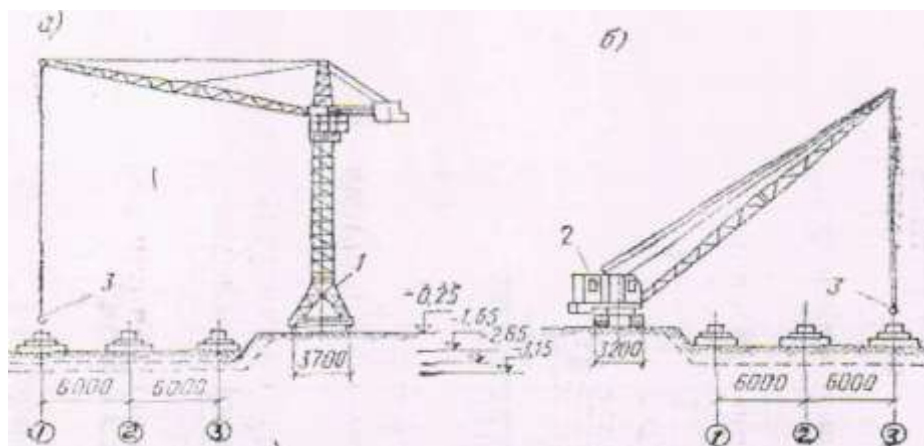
Схемы бетонирования фундаментов с помощью кранов
